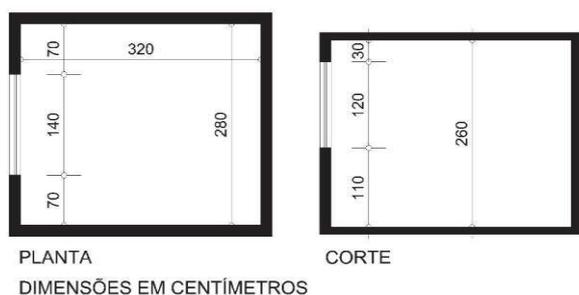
Planta e corte com dimensões do quarto do modelo da ZCBH.
